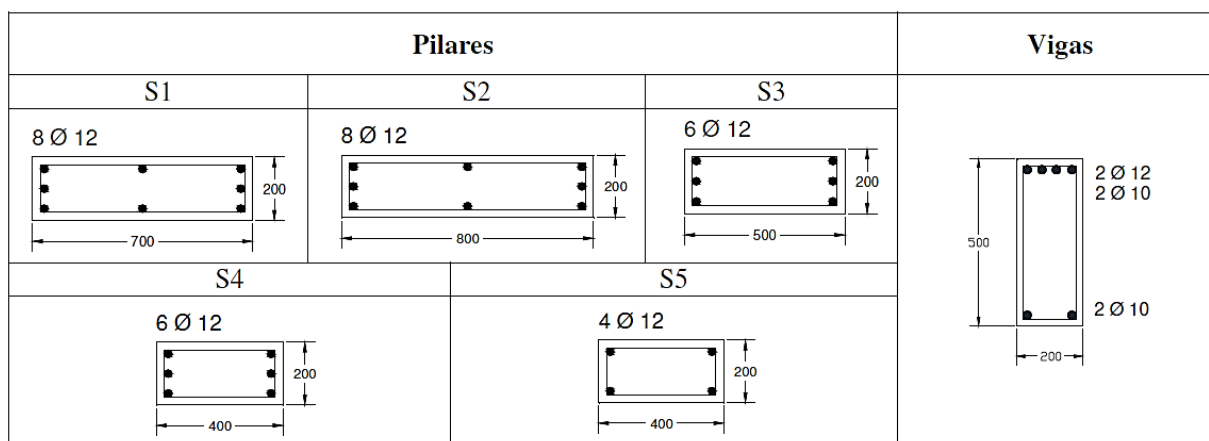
Secções transversais de pilares e vigas do modelo de pórtico (Marques, 2011).
